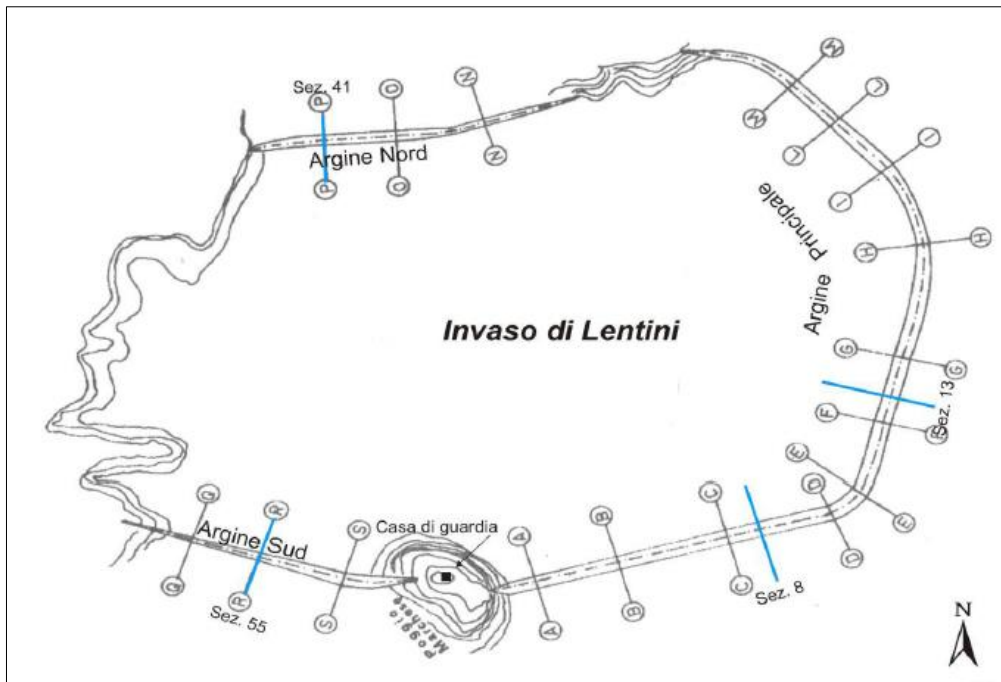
planimetria delle arginature dell'invaso Lentini (Asseverazione 1° semestre 2022)
